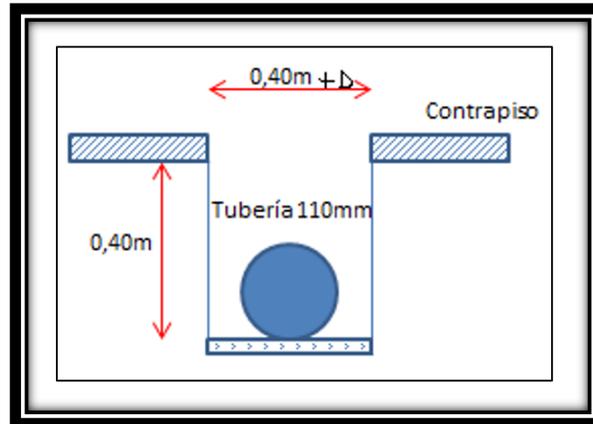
Excavación para instalación de tubería de alcantarillado
